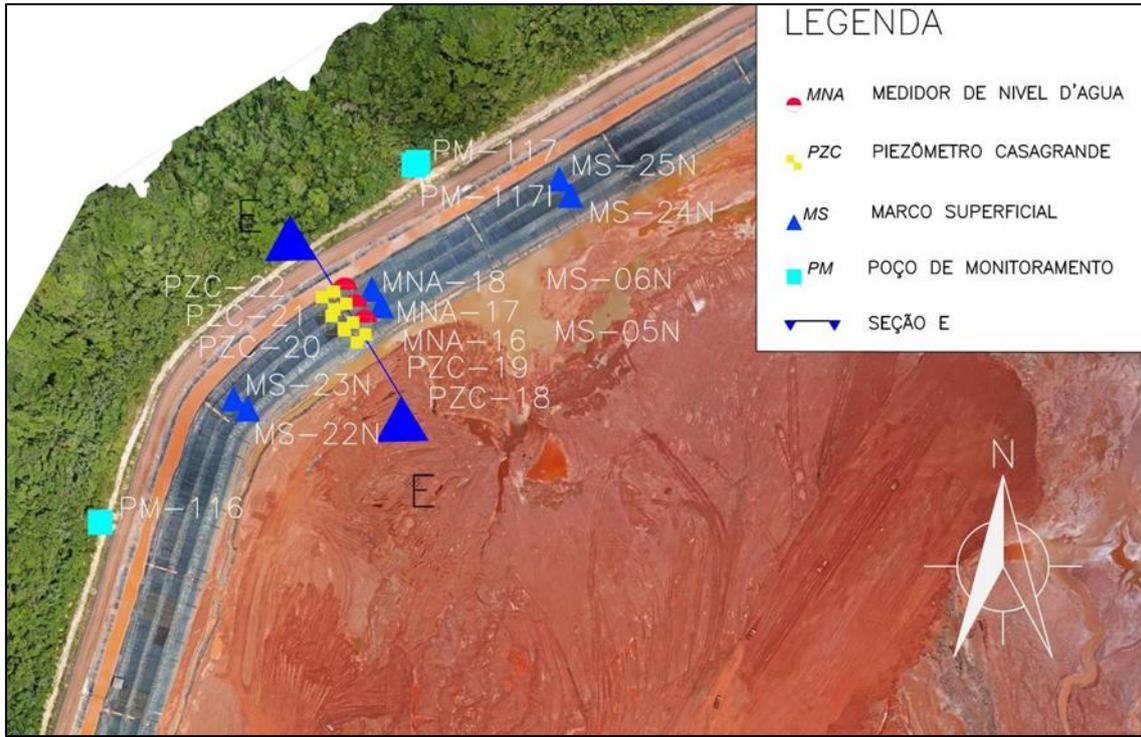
Localização em planta da instrumentação instalada na Seção E (PIMENTA DE AVILA, 2022)
